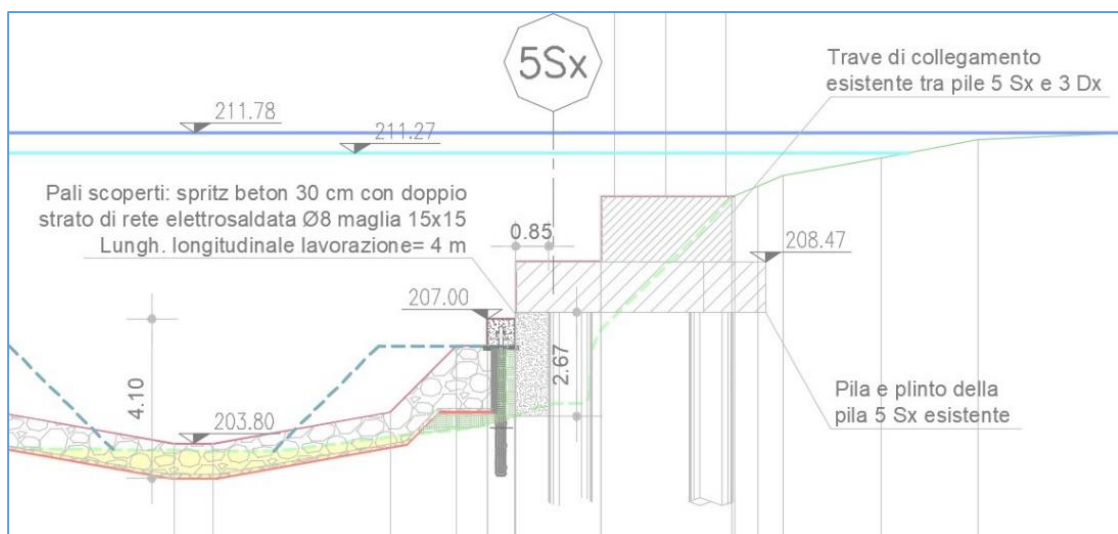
Intervento in corrispondenza delle pile in Dx idraulica nuovo progetto
